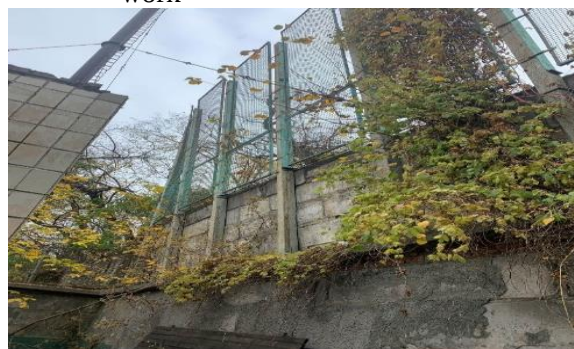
Відхилення від вертикалі огорожувальних конструкцій стадіону, внаслідок просідання та зсуву ґрунту
